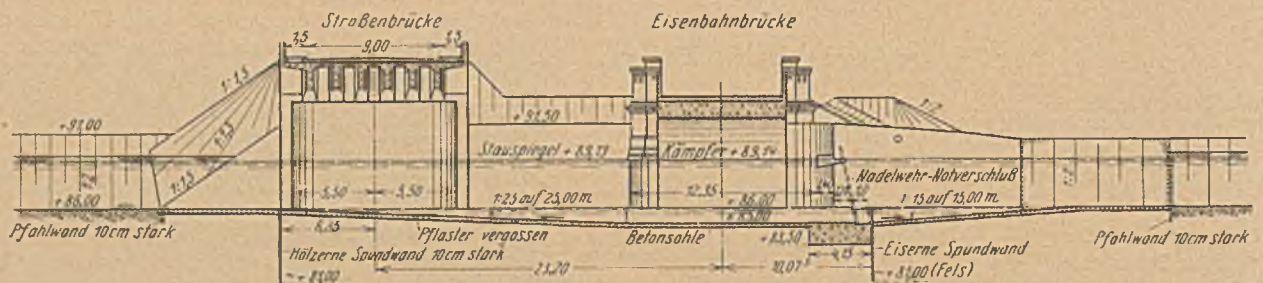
Einlaufbauwerk. Querschnitt durch die Brücken und den Notverschluß.
